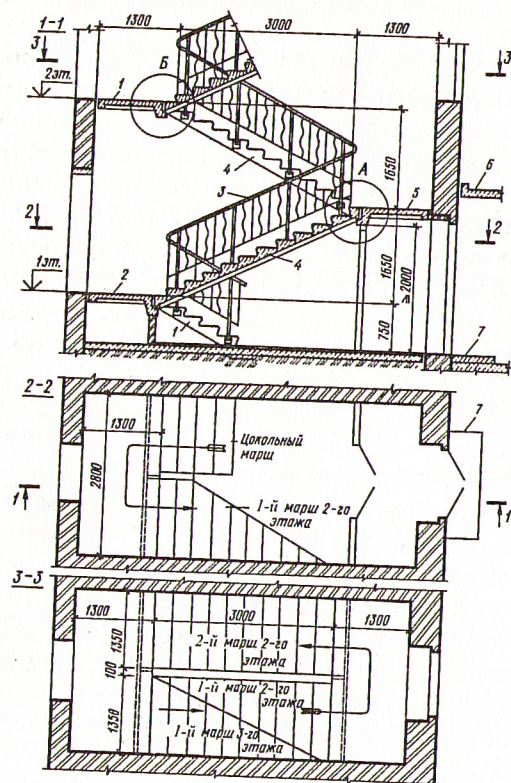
Двухмаршевая лестница (разрез и поэтажные планы):
